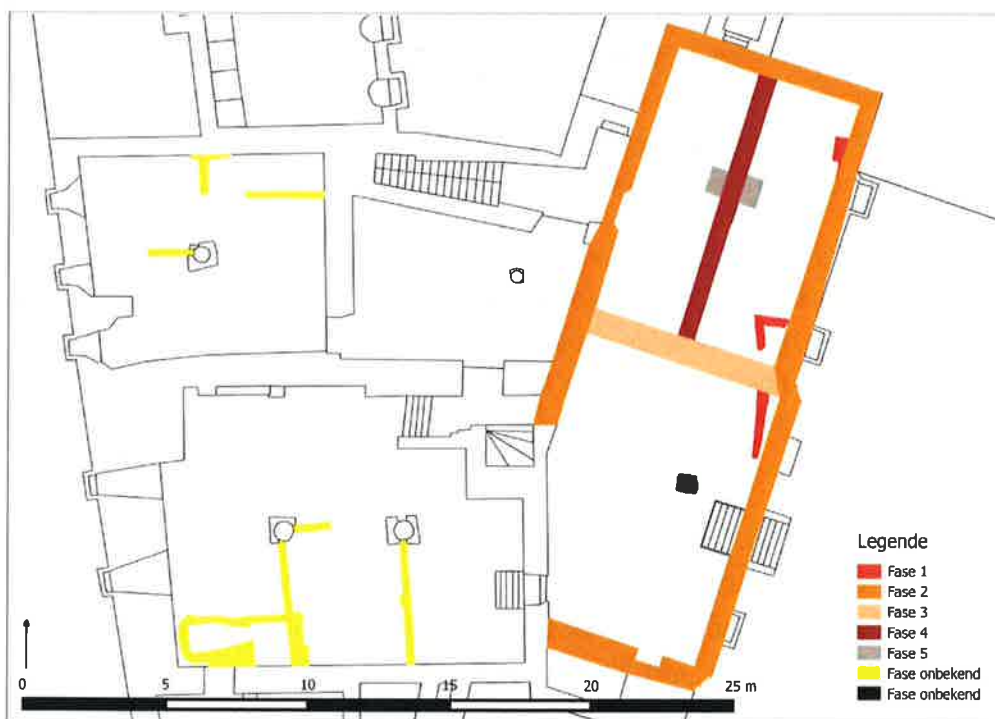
Faseringsplan van de bakstenen gebouwresten
